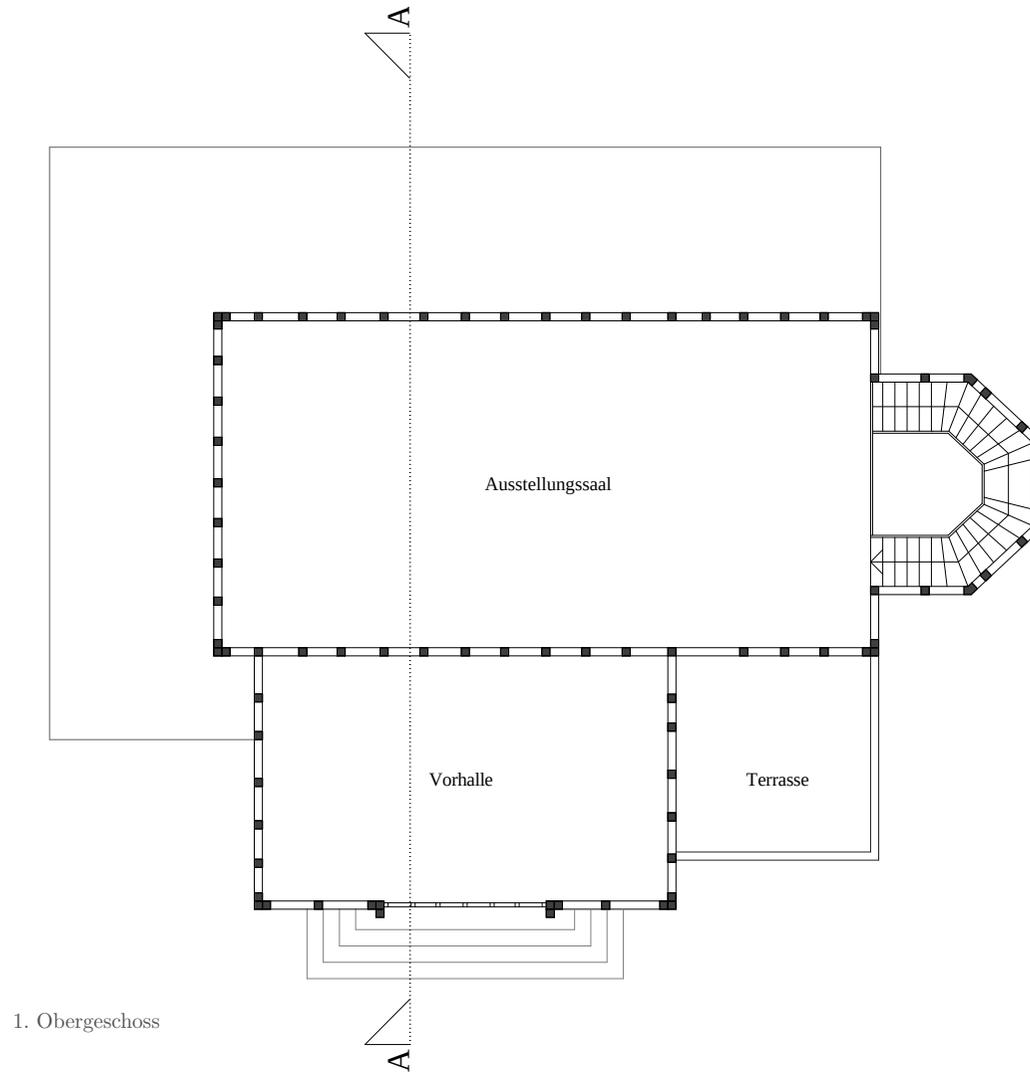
| Grundriss des rumänischen Pavillons
